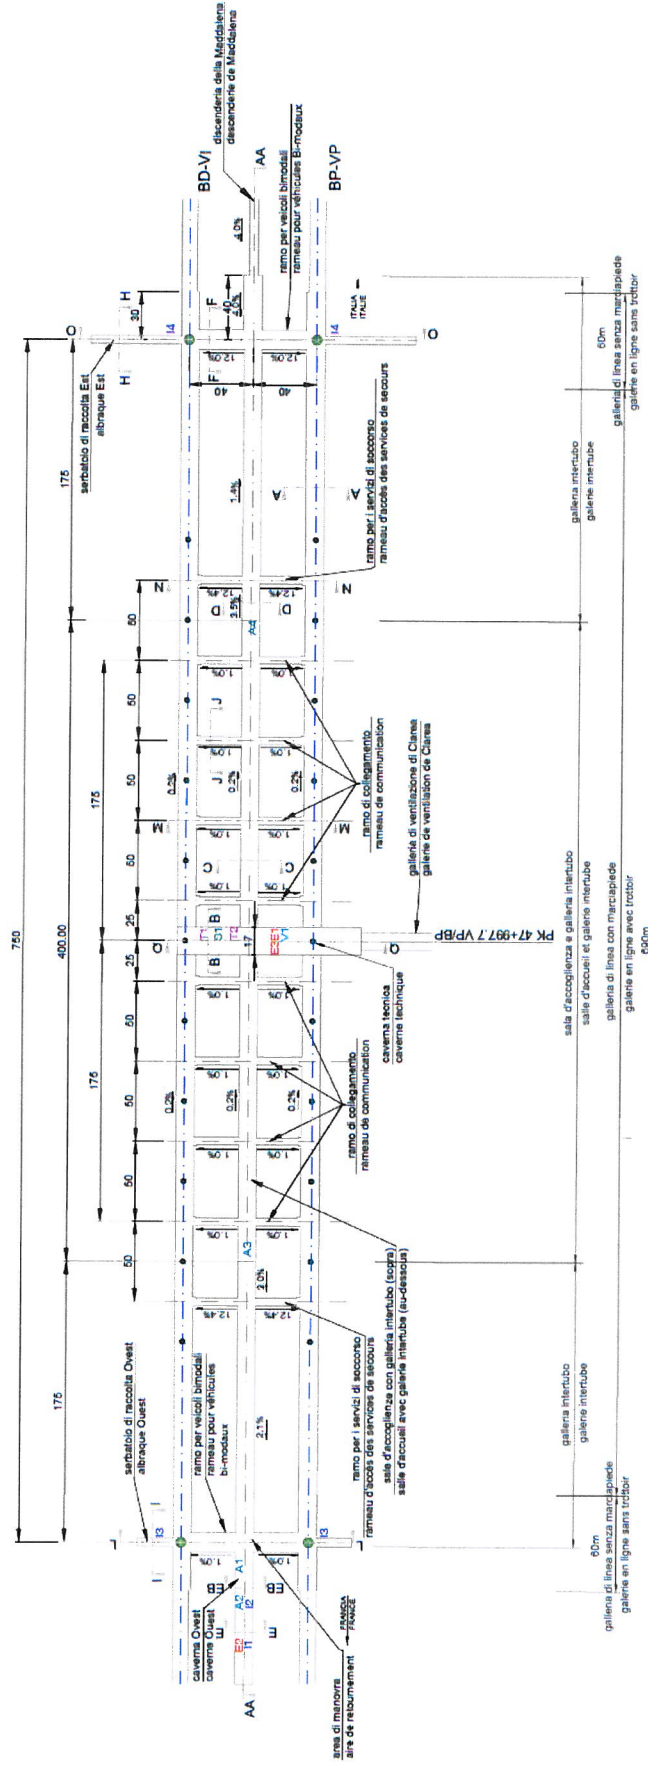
Planimetria dell' 'area di Clarea in fase definitiva
